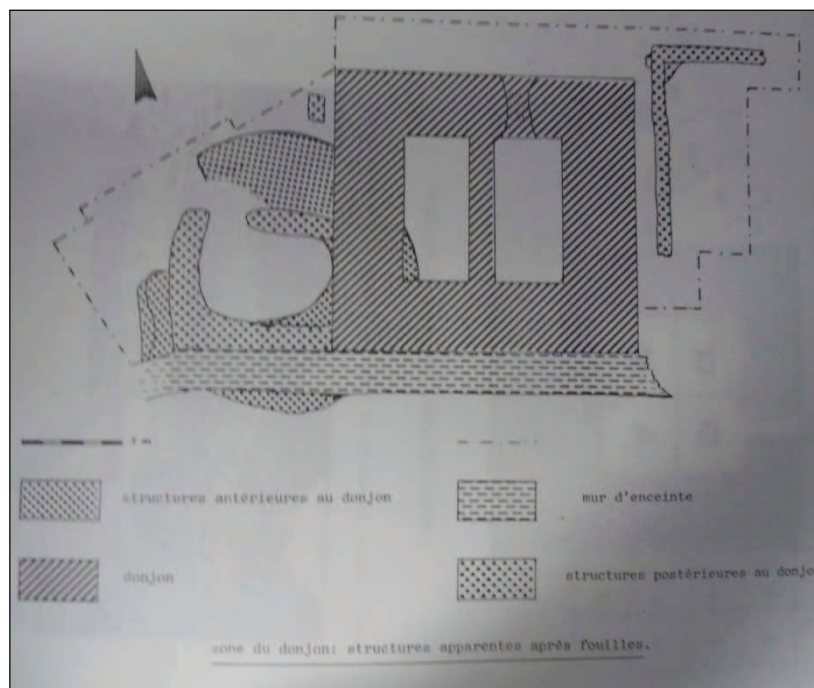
Plan des structures Sud (Mouton-Leparmentier 1989)
